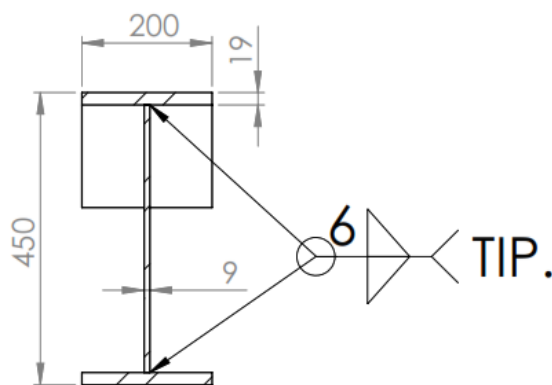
Detalle de soldadura Viga Principal
